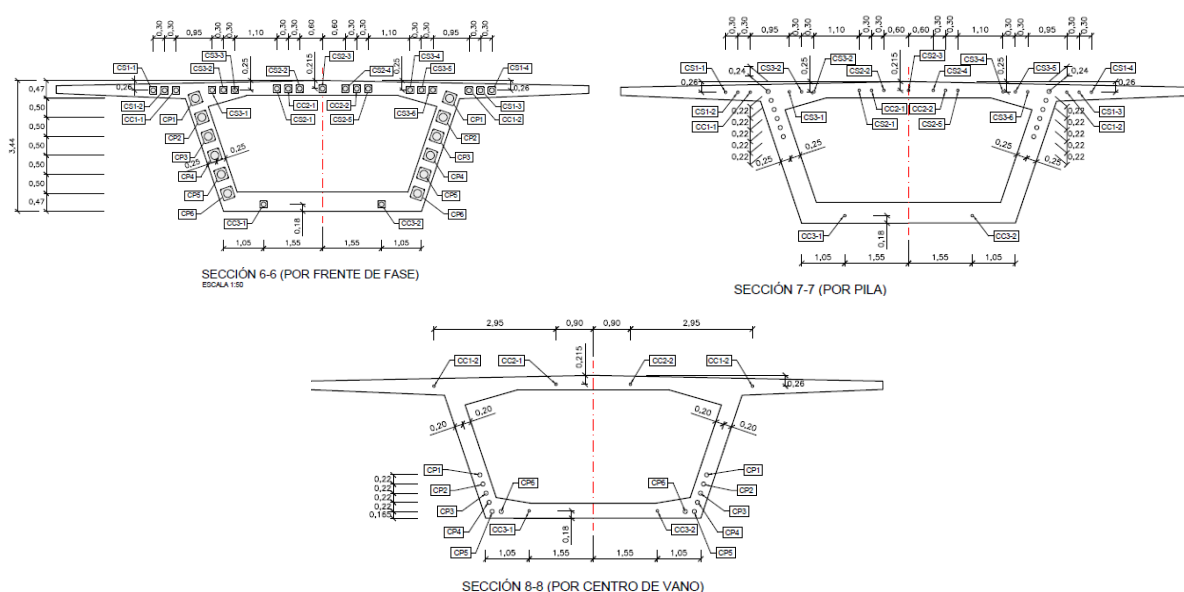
Secciones de pretensado por frente de fase, en pila y en centro de vano
